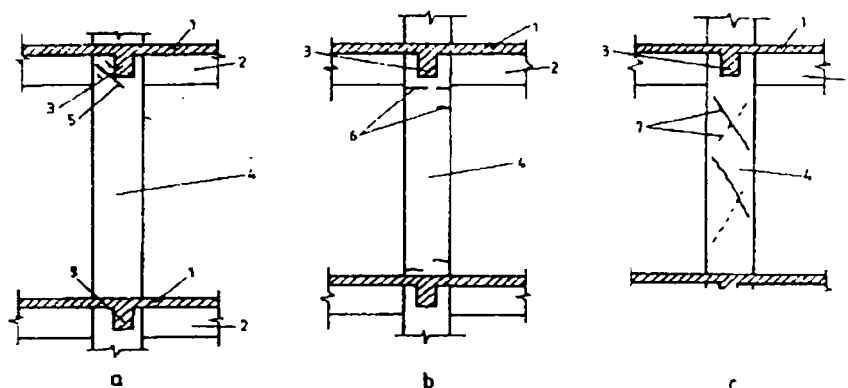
Degradari la stâlpii din beton armat;
